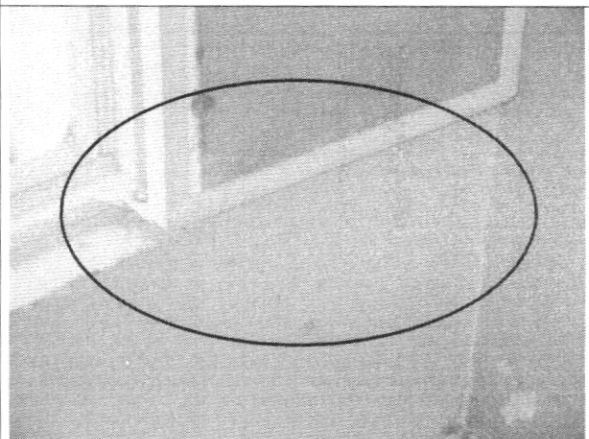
Fisuras muros de tercer piso, costado occidental
